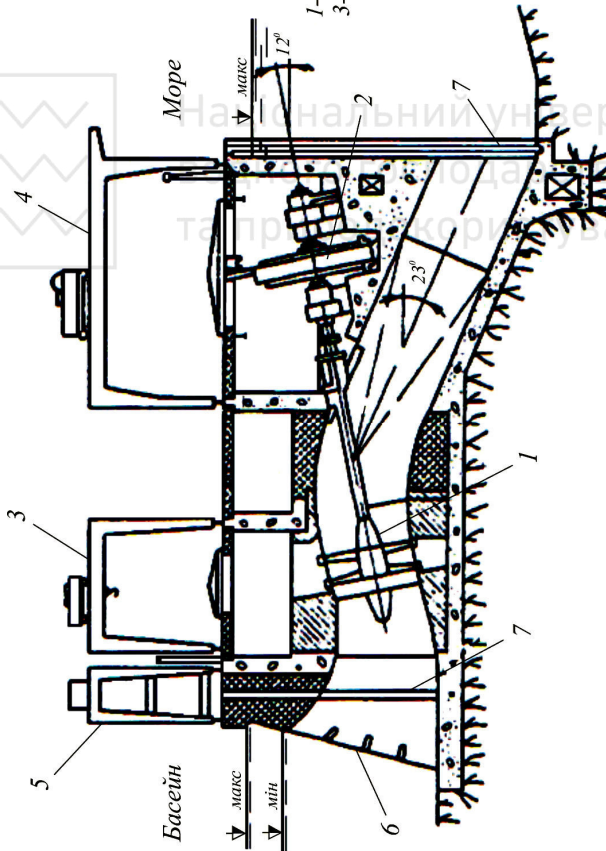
Поперечний переріз машинної будівлі ПЕС:
